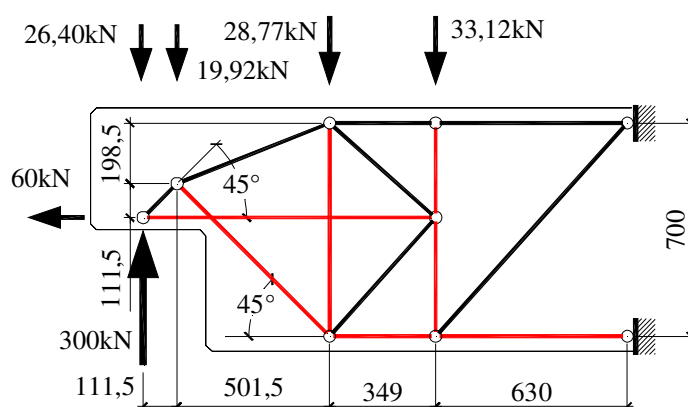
Konstruowanie i zbrojenie do przykładu 4.2, wyznaczone obliczeniowo
